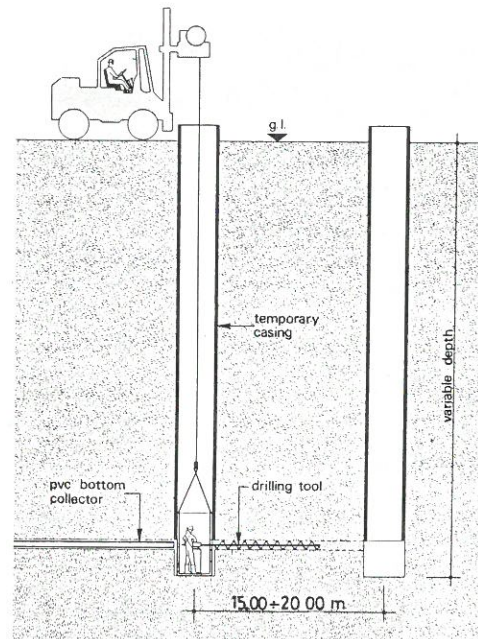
Schema della lavorazione per il collegamento dei pozzi tramite collettori alla base
